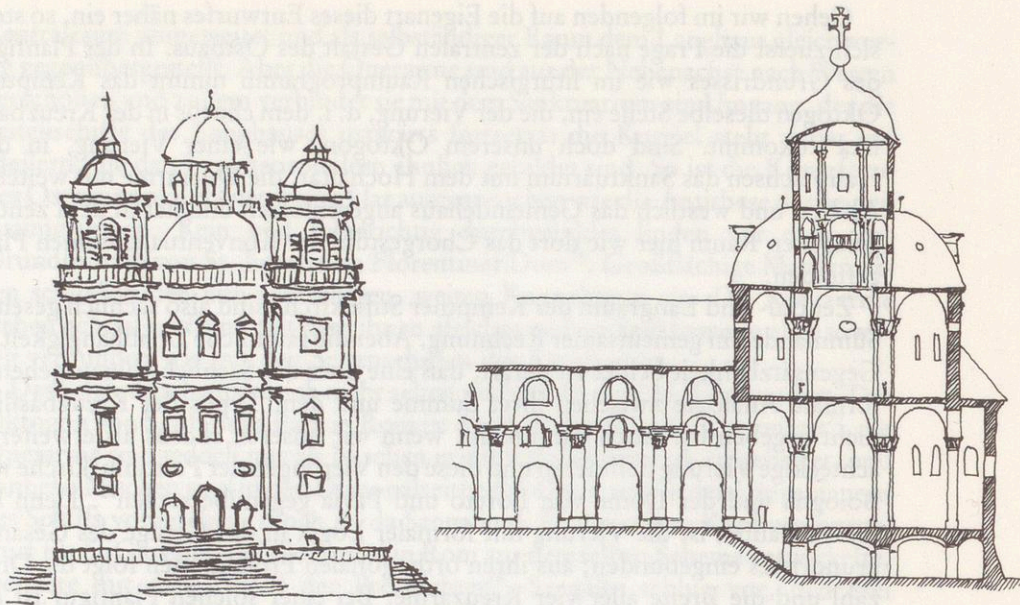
Kempten, Stiftskirche St. Lorenz, Skizzenhafte Rekonstruktion des Umbauprojekts Johann Serros, Maßstab etwa 1:800. Fassade mit perspektivisch verkleinerter Kuppel Konrad Hecht, Aufriß der Südansicht als Umzeichnung des Plans Abb. 4, Grundrisse und Schnitte Thomas Ludwig.
